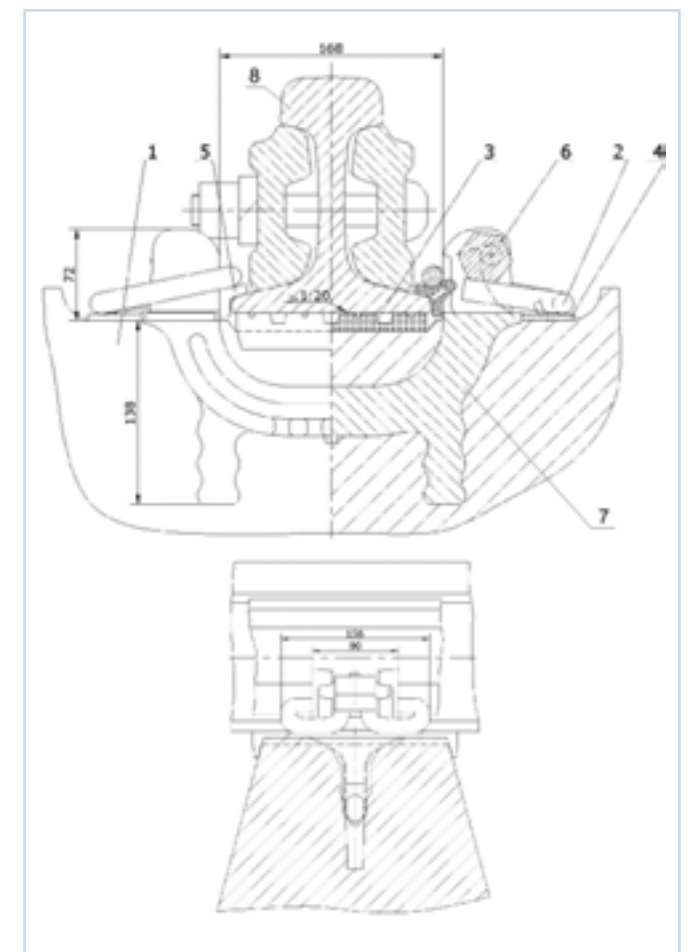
1 – железобетонная шпала; 2 – клемма; 3 – прокладка; 4 – подклемник; 5 – уголок изолирующий; 6 – монорегулятор; 7 – анкер; 8 – рельс.
